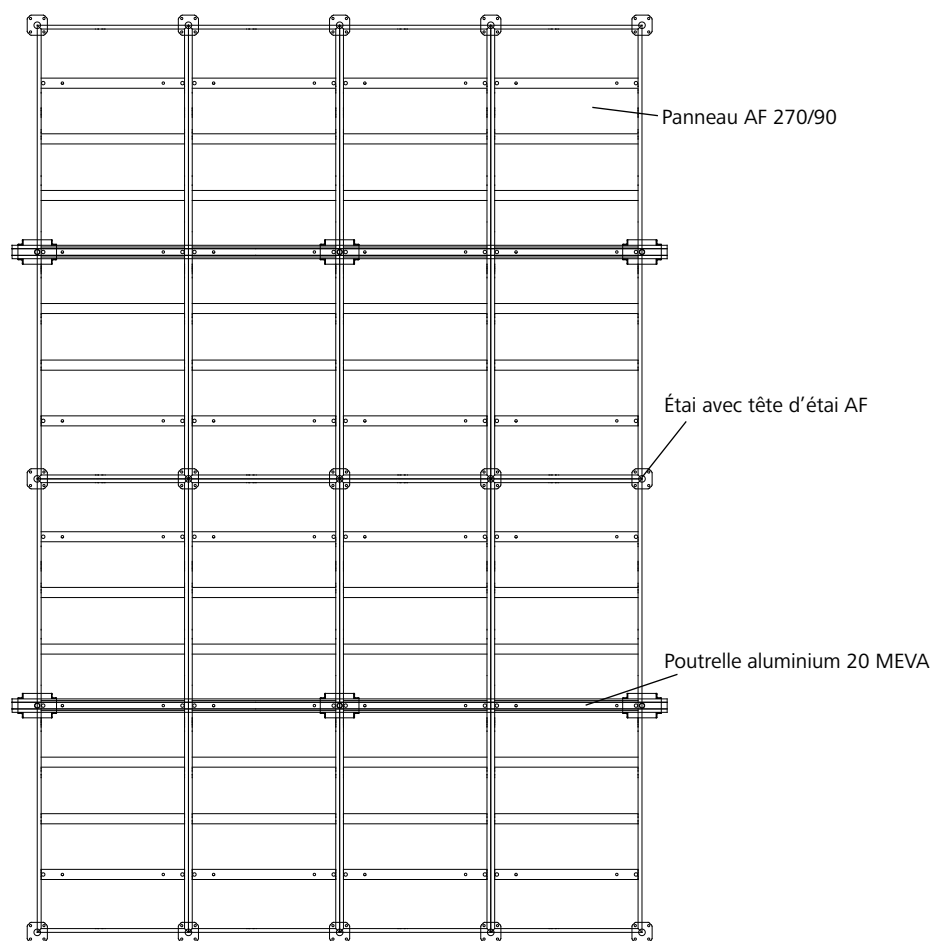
Deux poutrelles aluminium 20 MEVA utilisées comme poutre à deux travées
